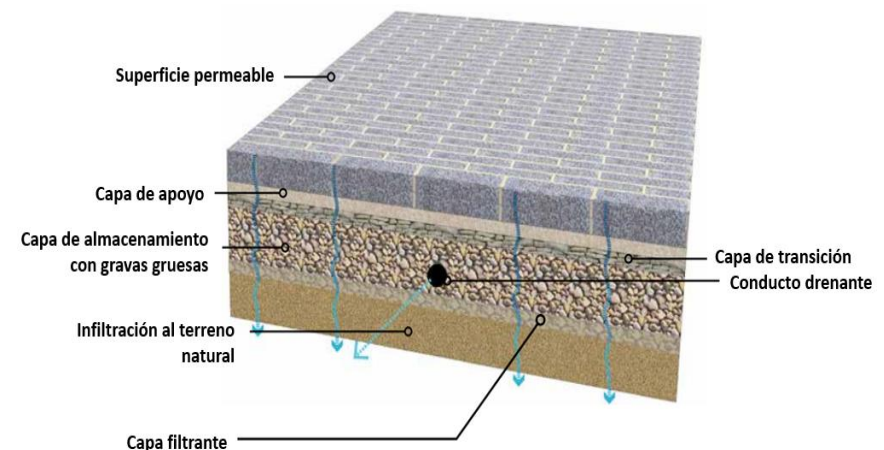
Esquema de un pavimento permeable. Fuente: Adaptado de Washington DC Department of Transportation (2014).
